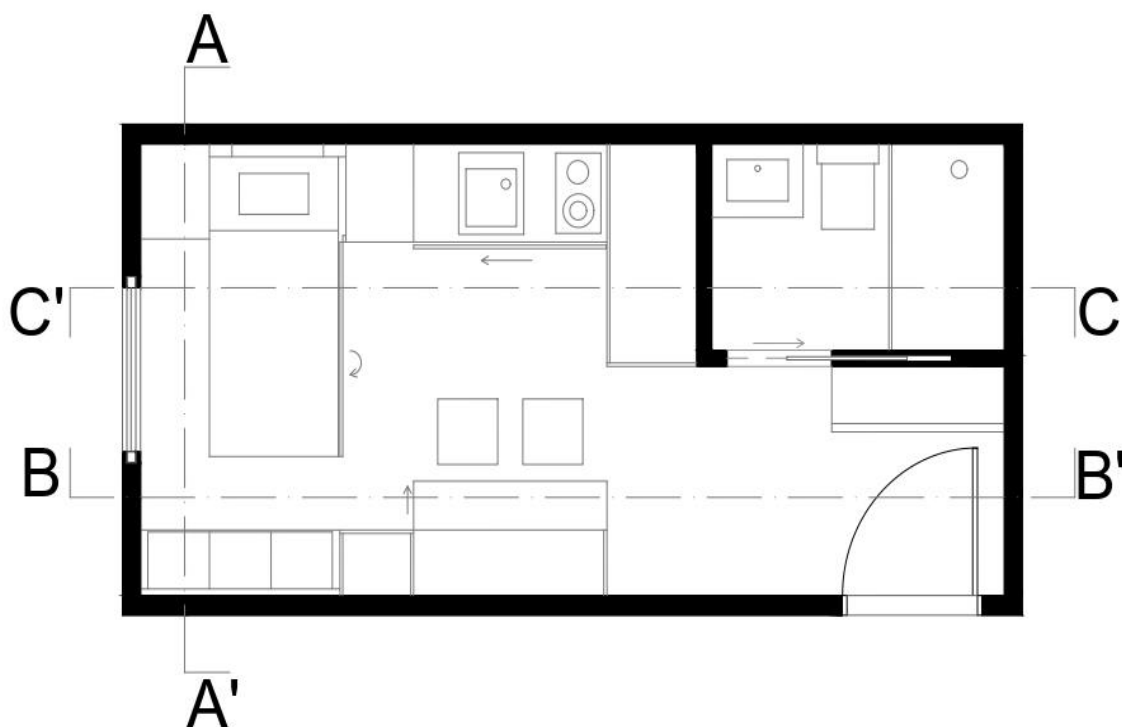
Planta do módulo 1 (Ferreira, 2020)
